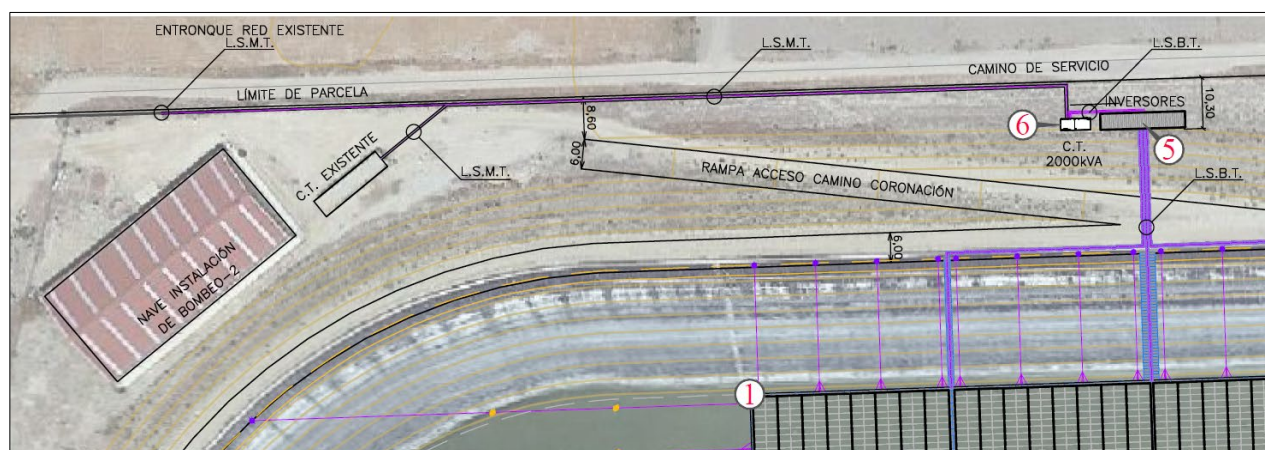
Equipos instalados en tierra en la Alternativa 2 junto a la balsa
